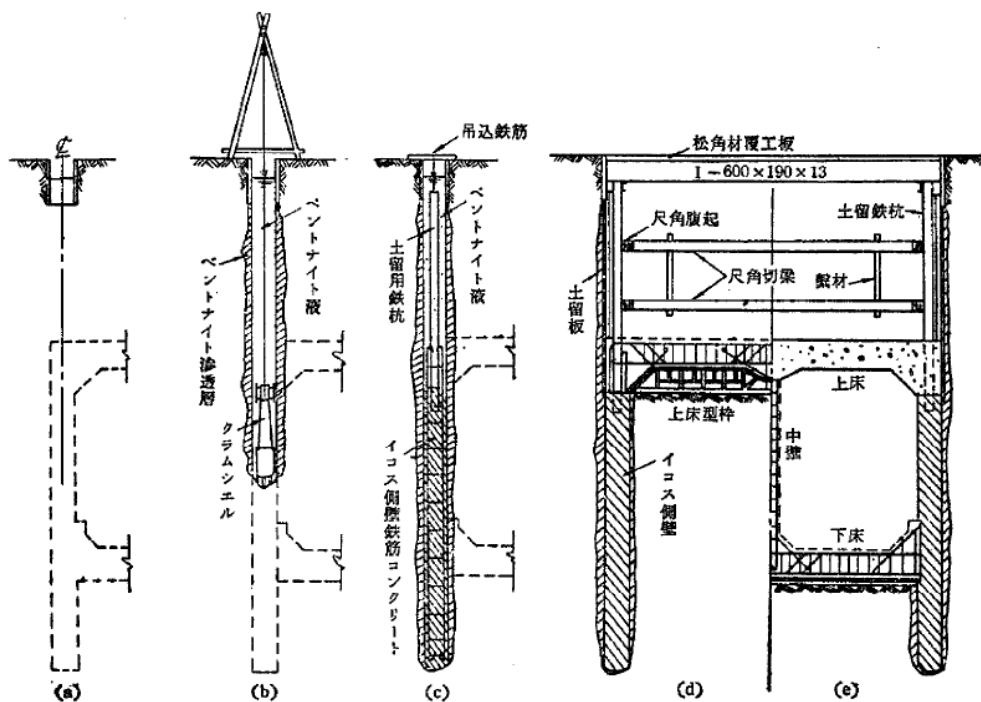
イコス工法による側壁の施工順序 (横断面)
